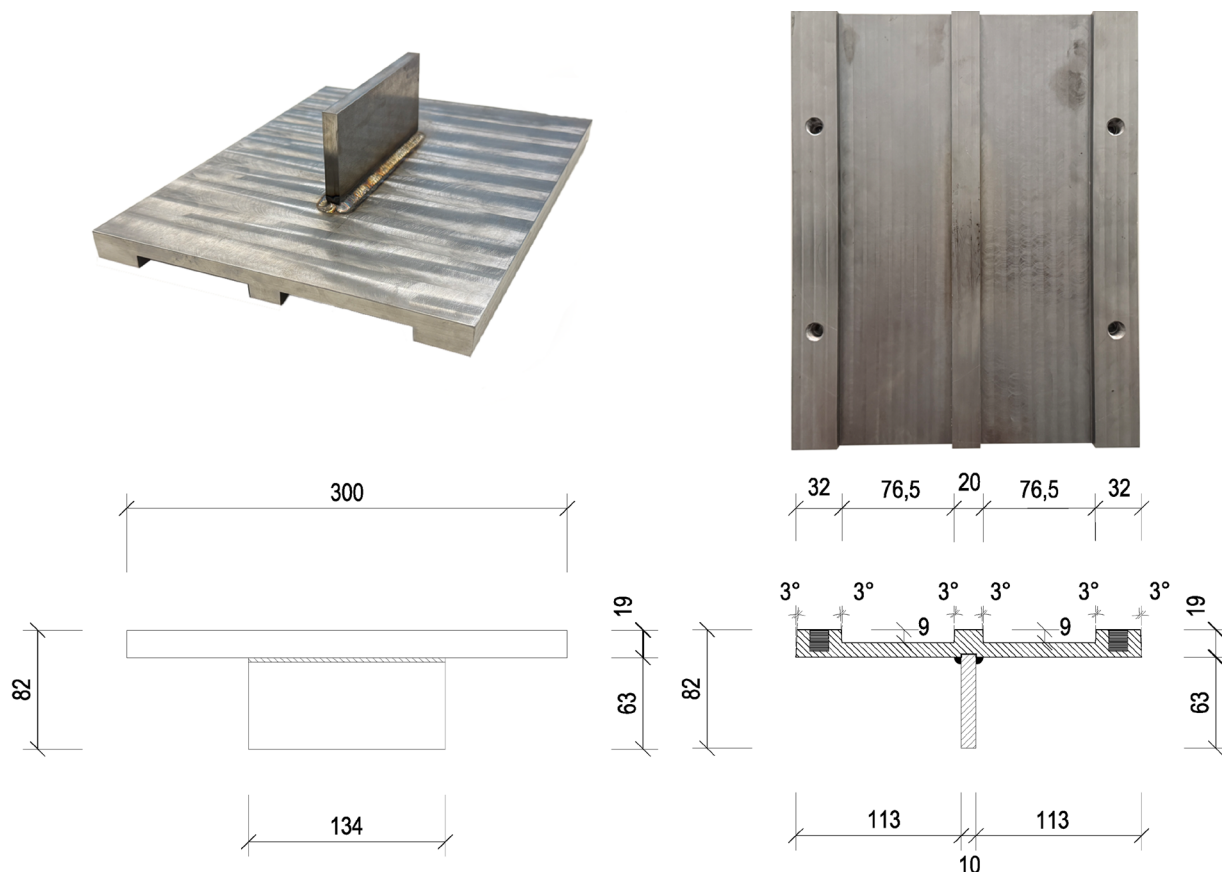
Anschlussblech mit drei trapezprofilierten Schubnocken aus Baustahl S235; Quelle: t-lab, RPTU Kaiserslautern-Landau
